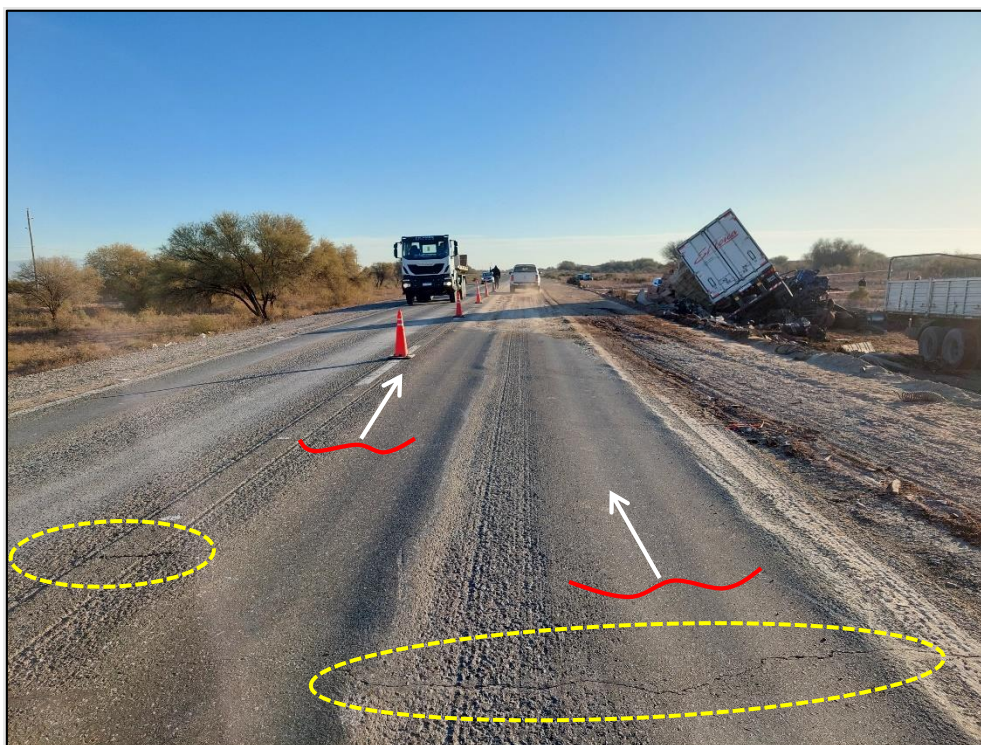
Vista panorámica de RN 40 de sur a norte (mano hacia San Juan). Se observa el estado de la calzada, con presencia de fisuras transversales y ahuellamiento. Fuente: JST, 2022
